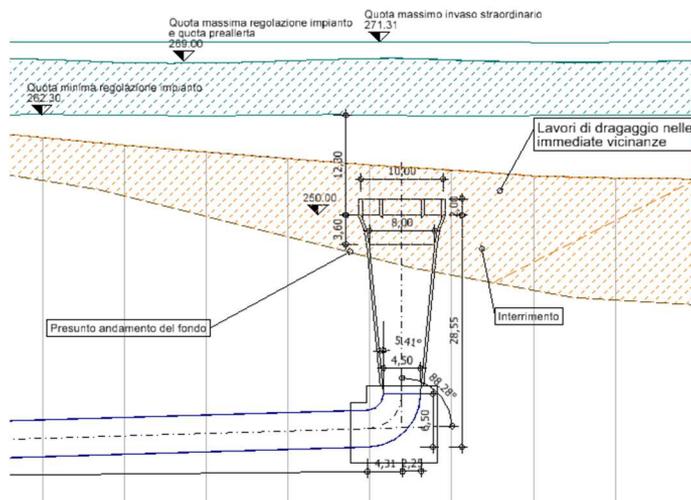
Sezione trasversale delle bocche di presa e restituzione (estratto Tavola PD-EP.21.2 del Progetto Definitivo).
